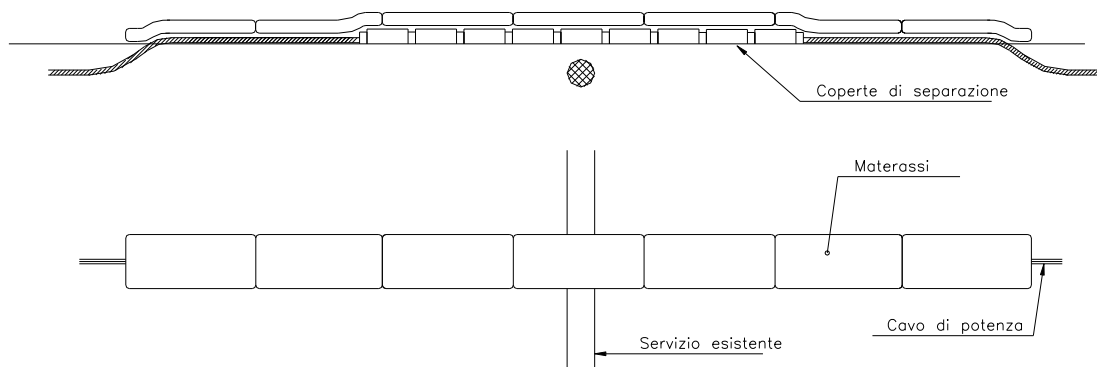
Particolare di attraversamento gasdotto o tubazione
